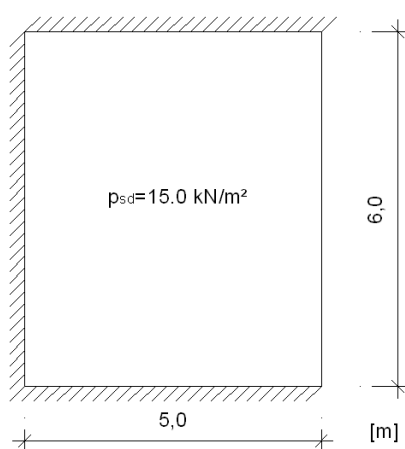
Geometria e carga para a laje simplesmente apoiada
